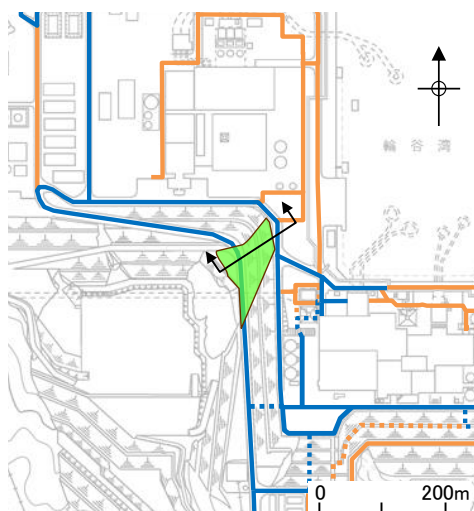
33m盤盛土斜面の断面位置図
